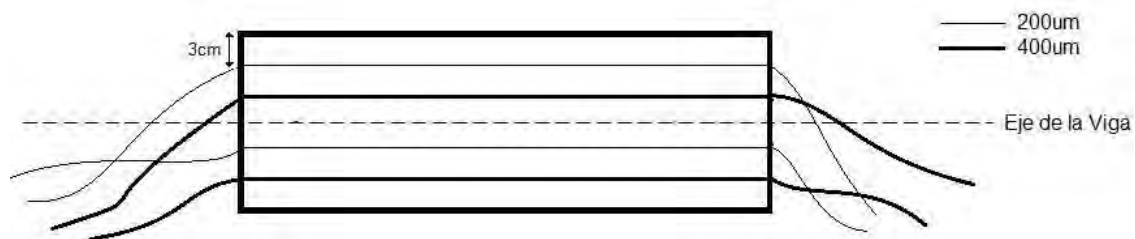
Vista lateral de la viga y la distribución de las fibras ópticas.
